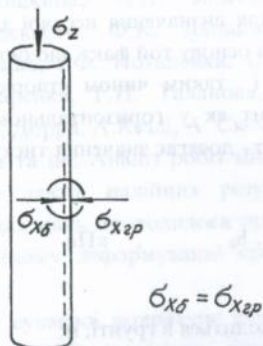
Схема тиску бетону на бокову поверхню свердловини:
